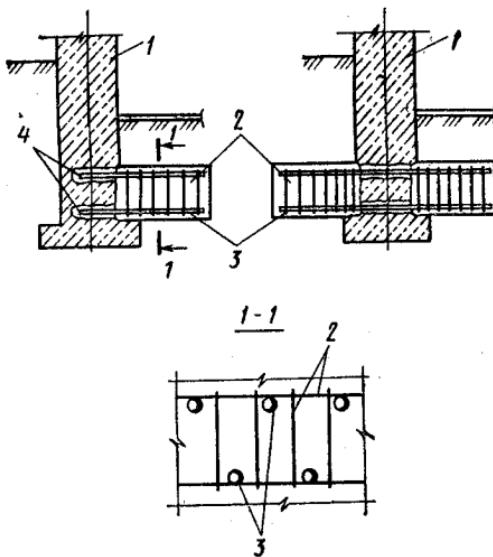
Усиление ленточных фундаментов наращиванием:
